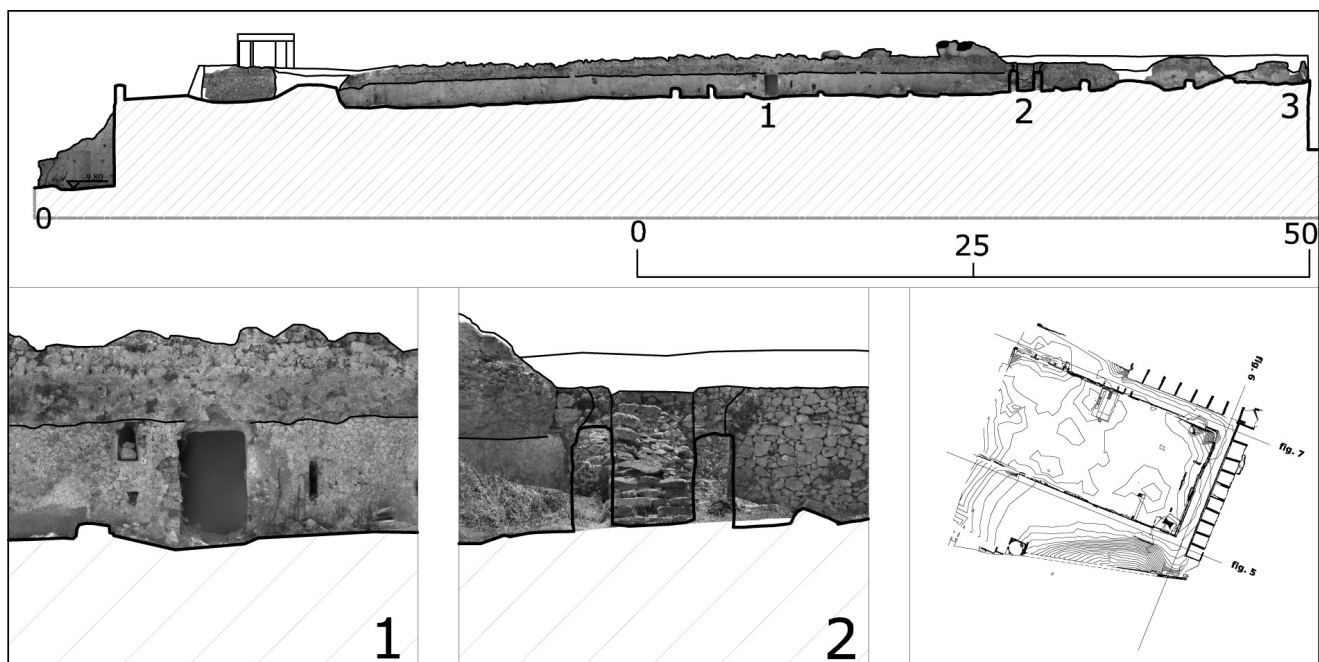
Sezione prospetto del lato nord-est della sostruzione della terrazza superiore (vista nord-est/sud-ovest). In evidenza aperture entro la sostruzione e posizionamento delle sezioni prospetto.
